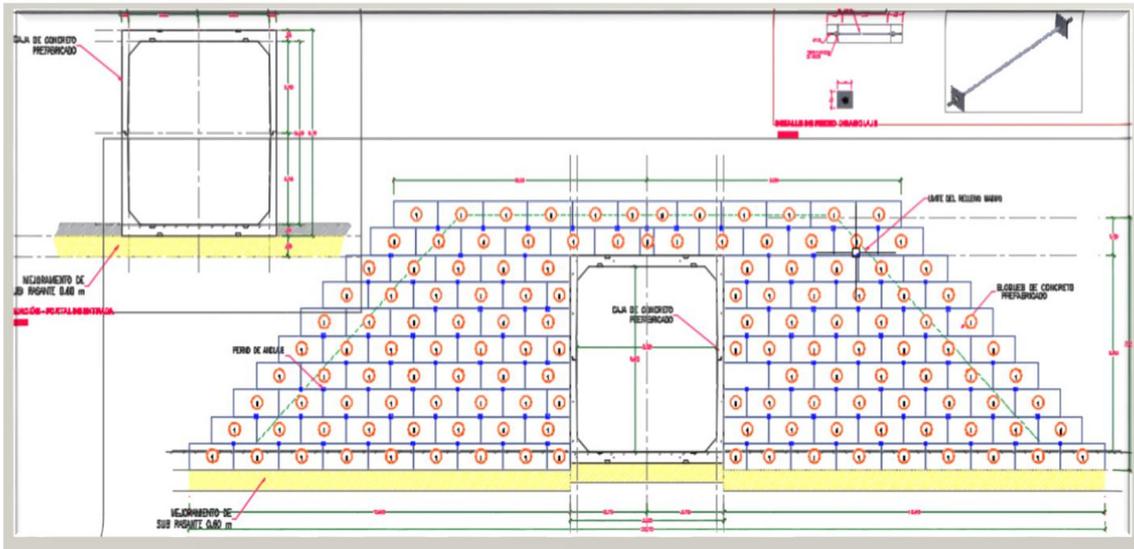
Sección típica de montaje de Falso Túnel y Portal tipo Box Culvert, dos piezas. Superior e Inferior.
